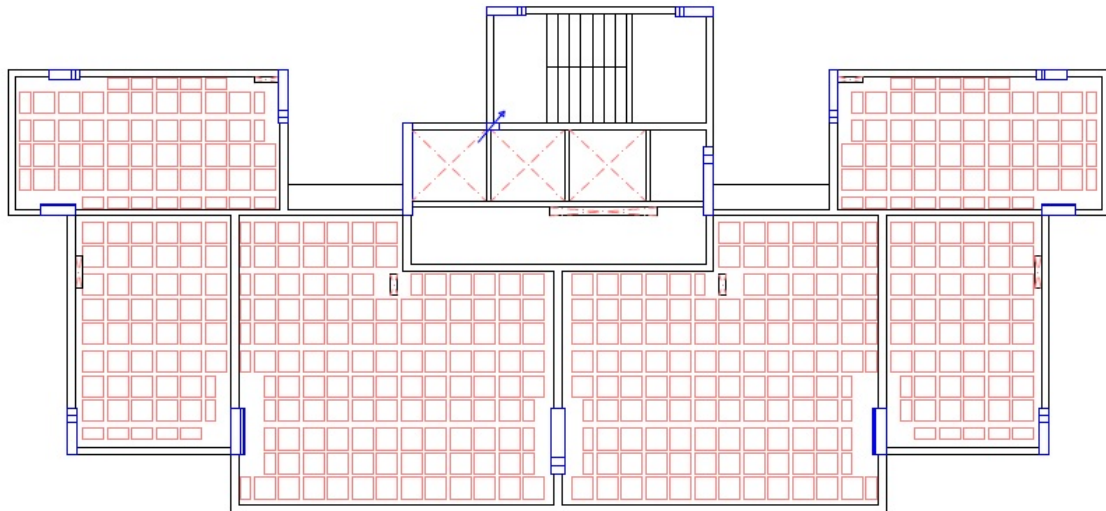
Estudo de Caso A: Modelo Fôrma Laje Nervurada do Pavimento Tipo.
